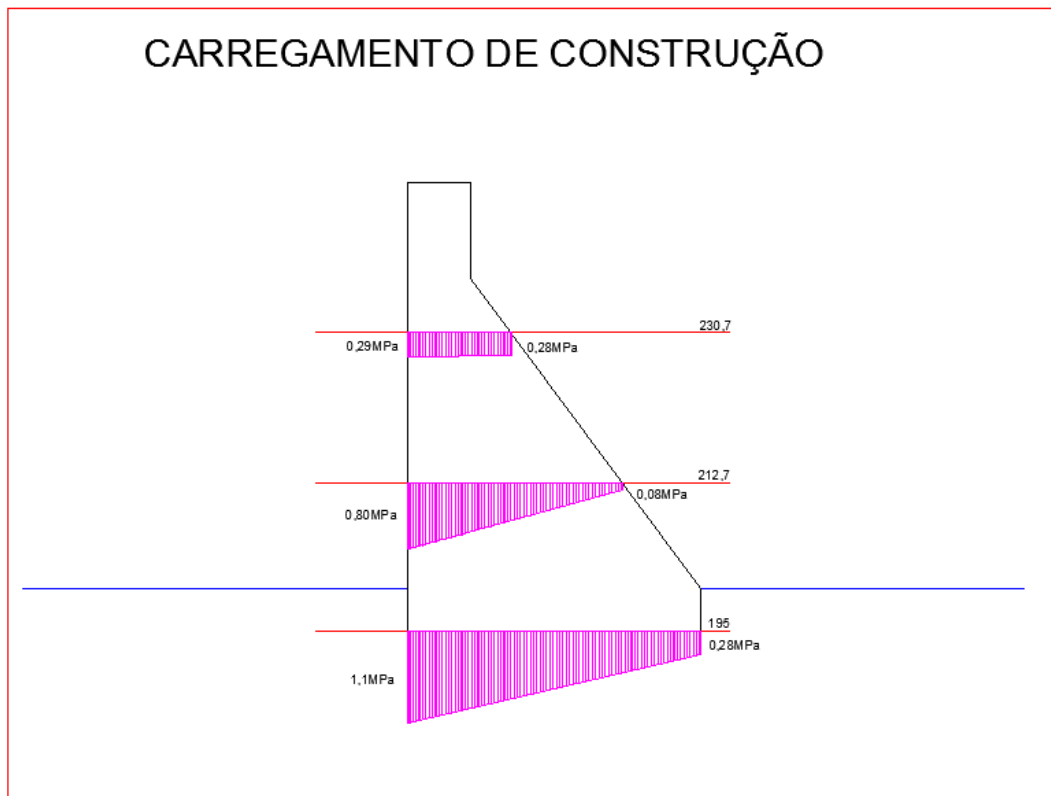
Diagrama de tensões normais nas juntas horizontais para condição de construção
